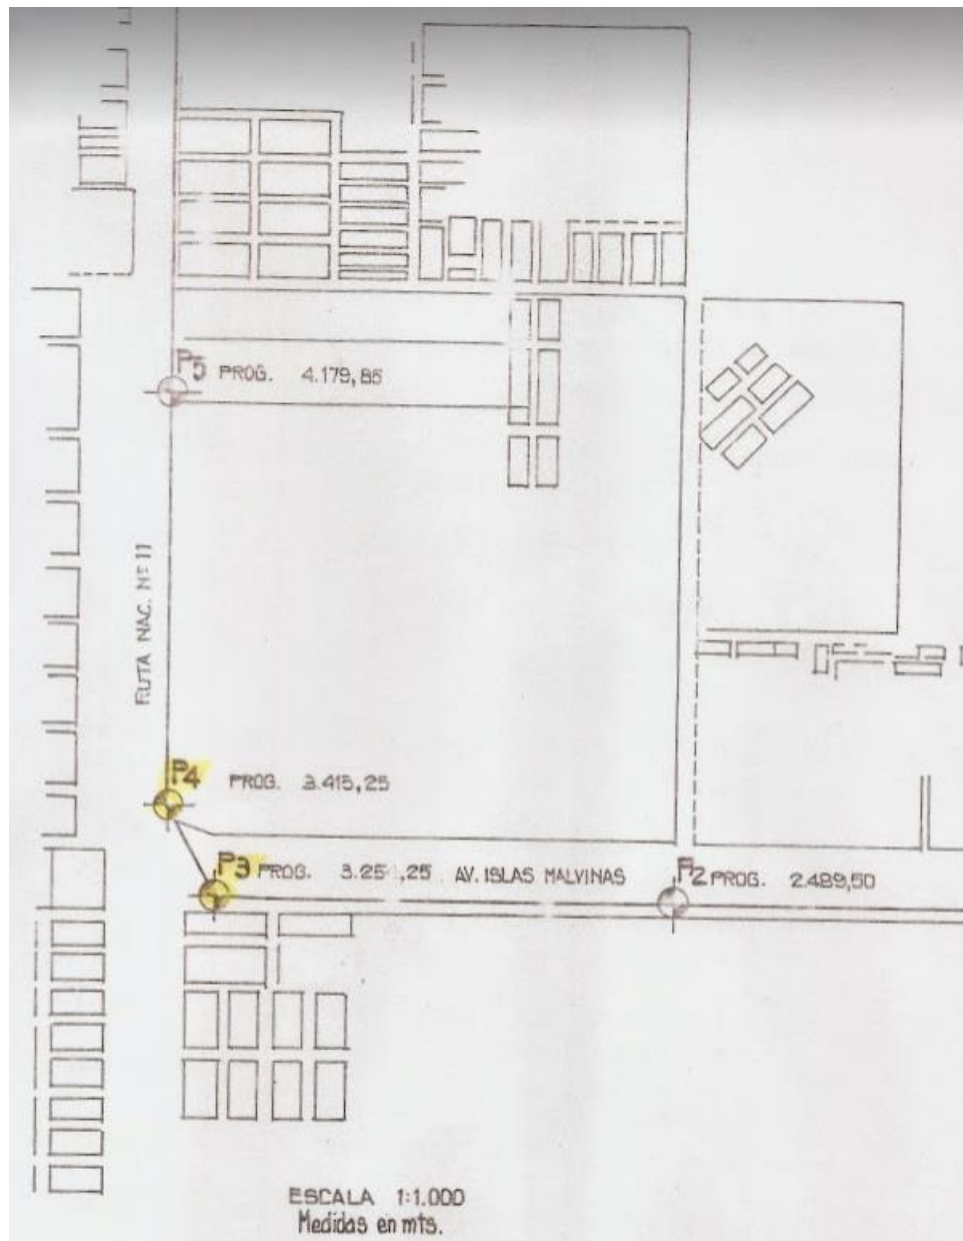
Ubicación del terreno y puntos de ensayo. Planta general. (fuente: Laboratorio de Suelo, UNNE- FI.)
